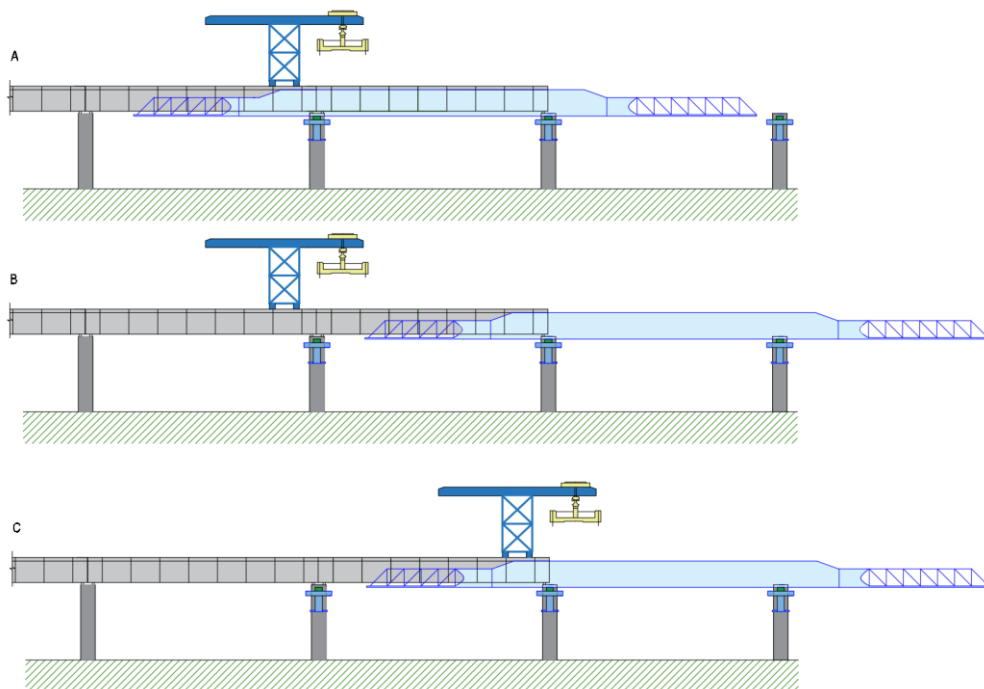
Základné časti montážnej súpravy s nosným trámom pod mostovkou (SCS).
